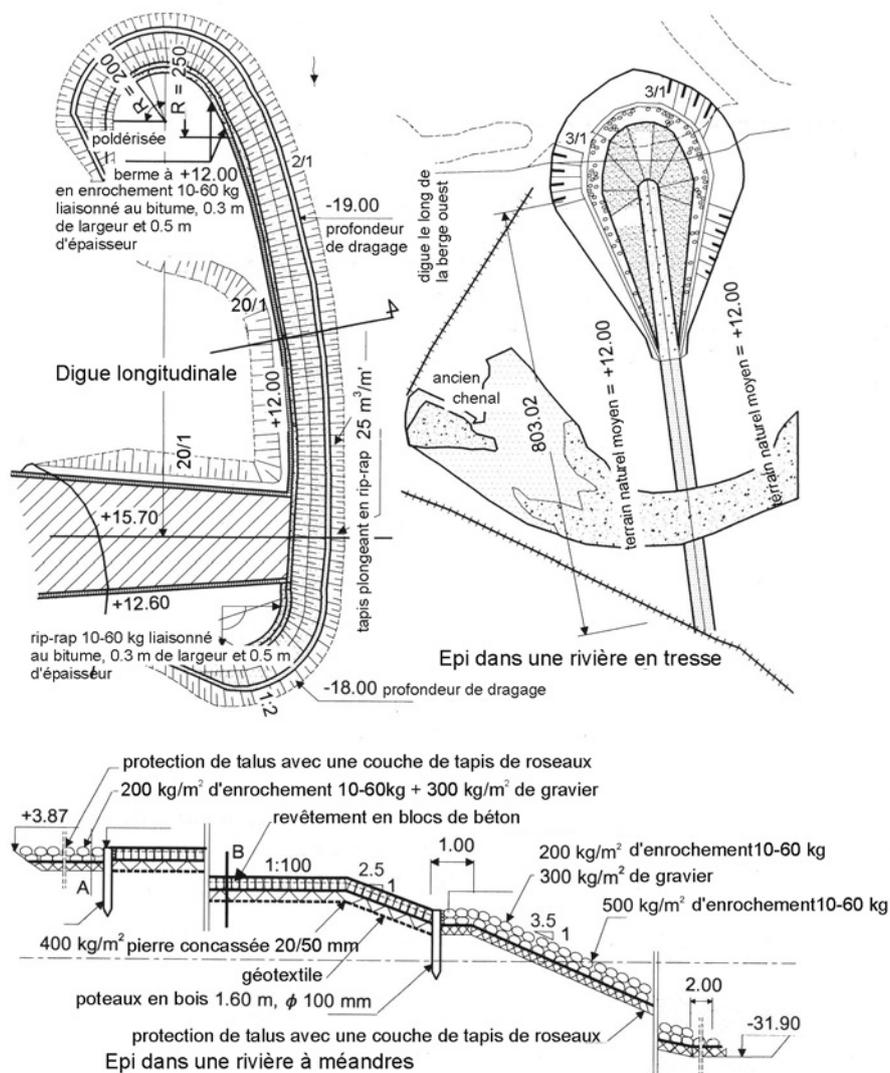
Exemples de musoirs d'épis et de digues longitudinales
